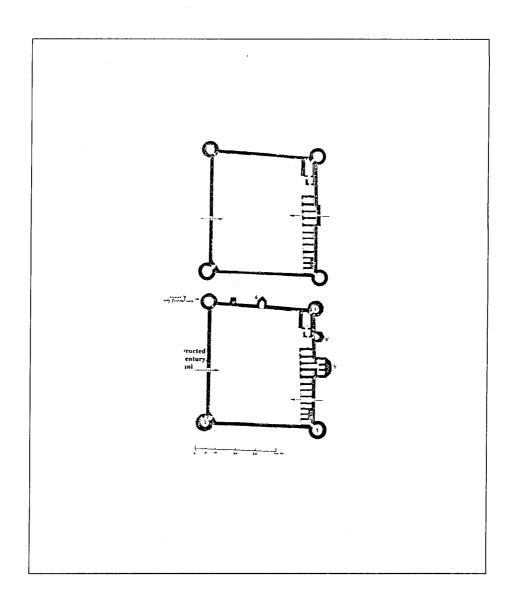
مسقط أفقي لمحناق قلعة بإستانبول (عن :Ütkular) .
